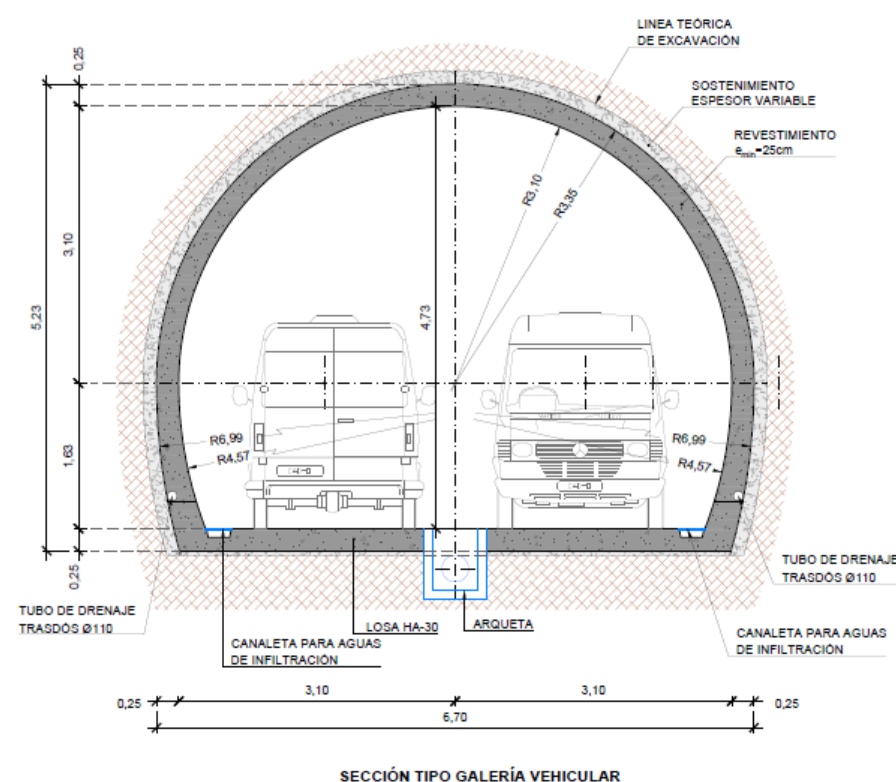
Sección tipo para las galerías de emergencia vehiculares.
